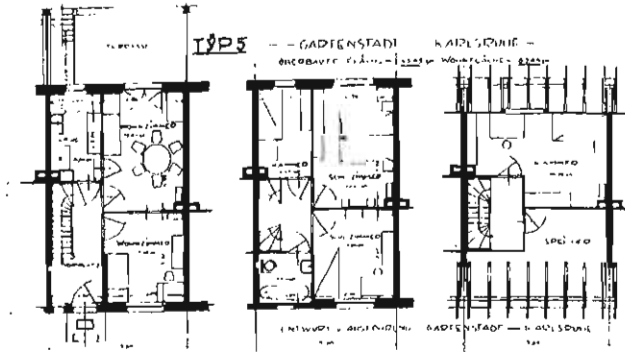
Grundrißtyp 1b (mit einem dritten Raum im Erdgeschoß)
